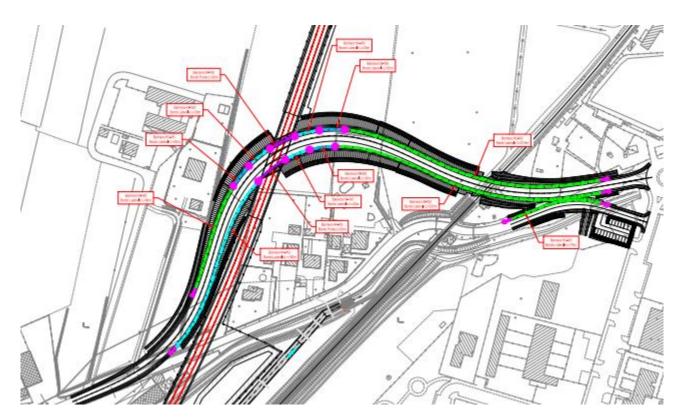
Stralcio planimetrico della tipologia di barriere lungo il tracciato della viabilità NV04
